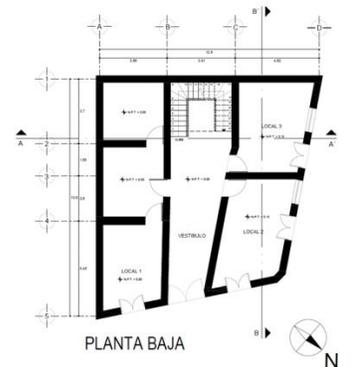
Planta en Revit. Fuente: Durán Méndez (20)
